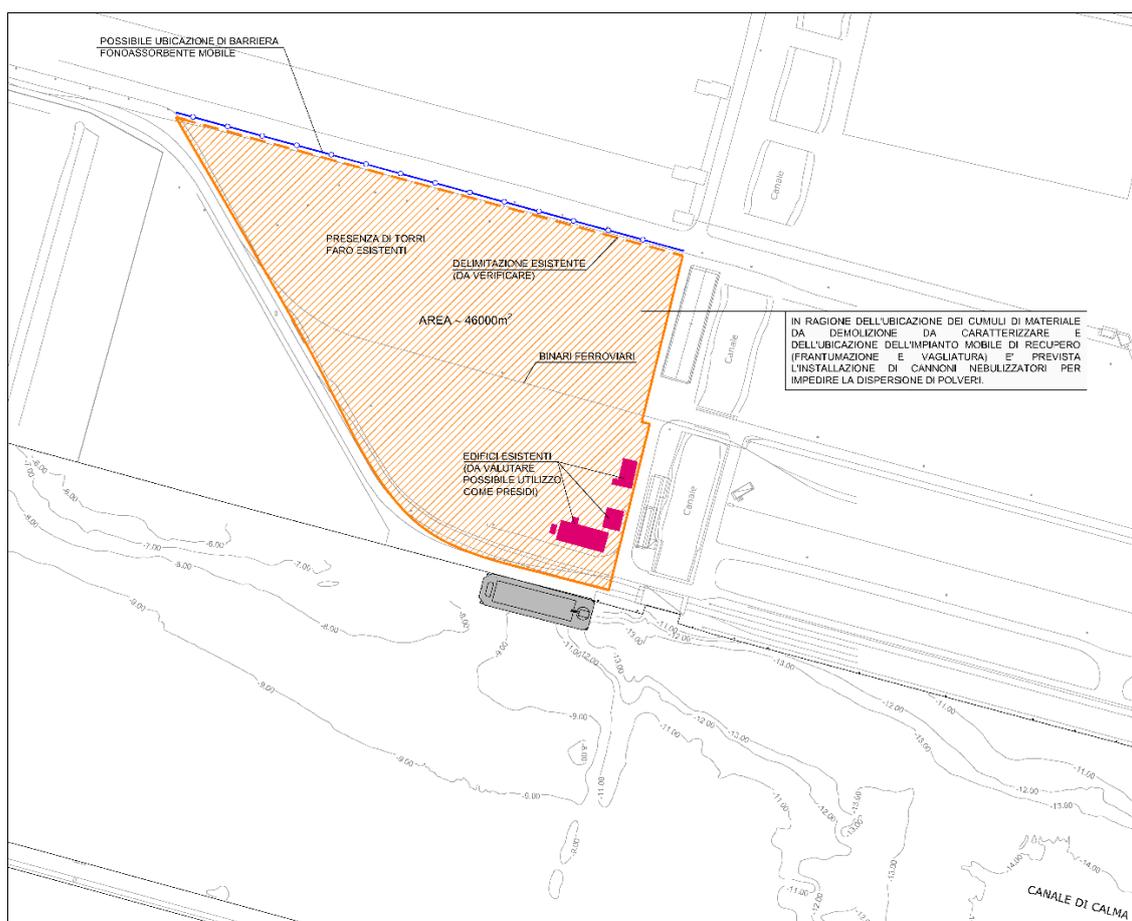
AREA EX ILVA PER STOCCAGGIO/LAVORAZIONE MATERIALI - PLANIMETRIA
